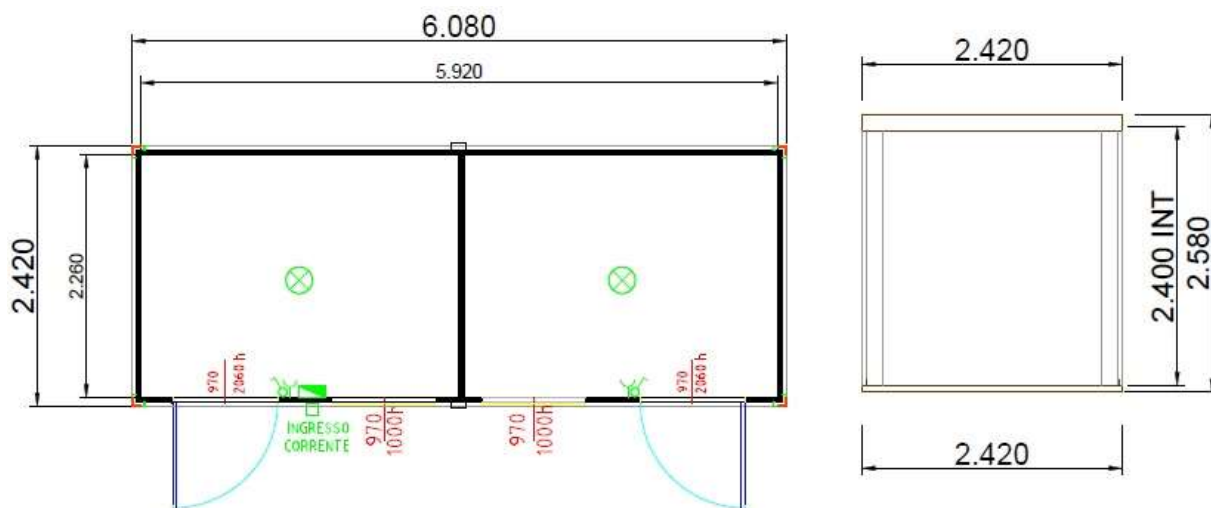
Pianta e sezione monoblocco ad uso locali ufficio
